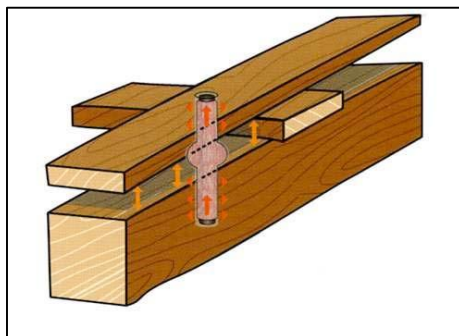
Système CARPO de raidissement de planchers en bois
